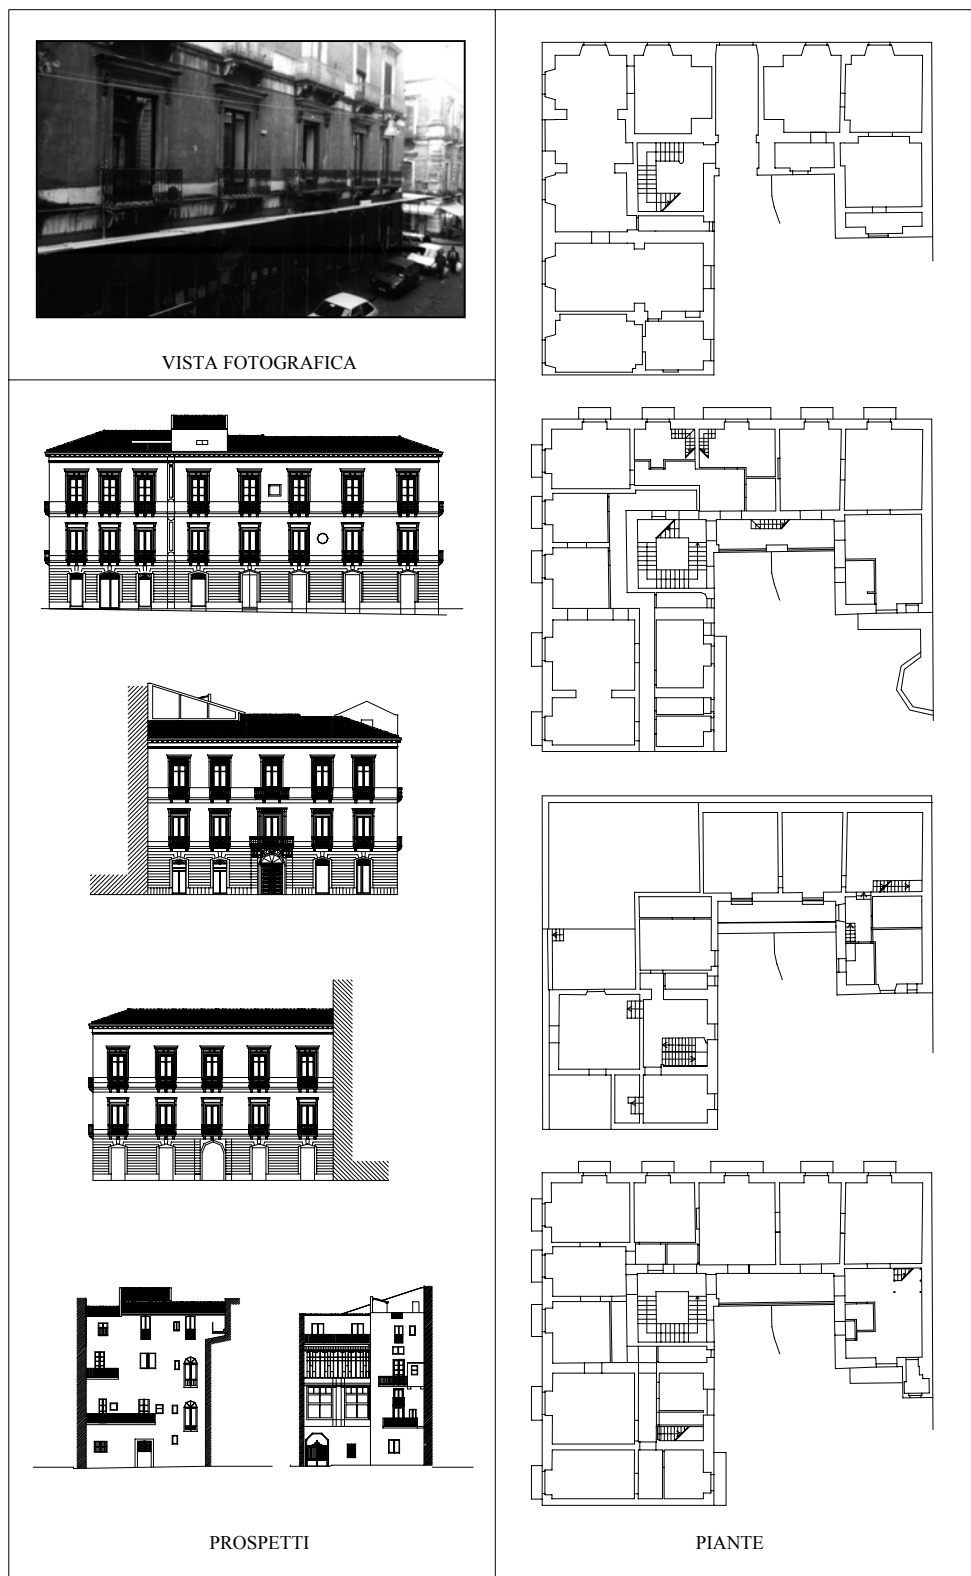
Vista fotografica, piante e prospetti dell'edificio in via Verdi.
